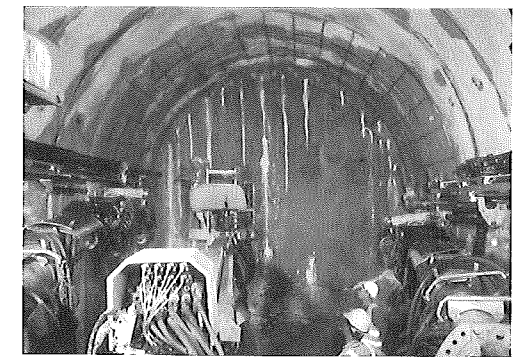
長尺鋼管フォアパイリング施工状況(河川横断面部)
